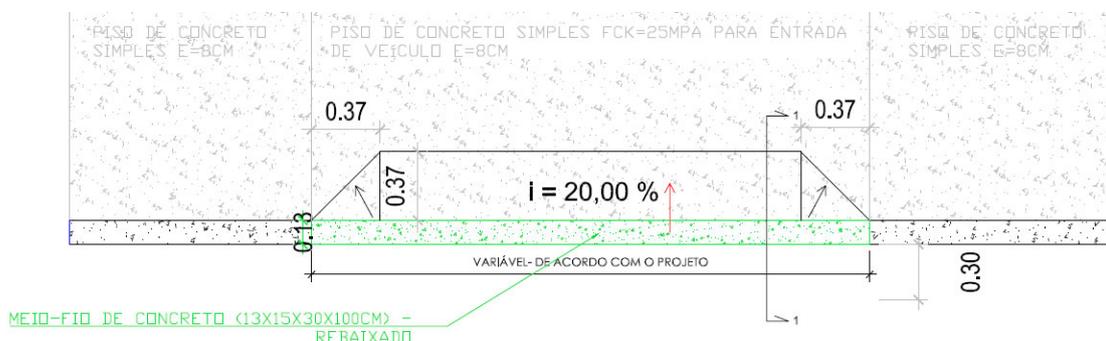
Detalhe construtivo em planta baixa esquemática das rampas de garagem de veículos leves a executar na calçada de concreto simples do lado direito da Rua B e nas demais vias do bairro COHAB
